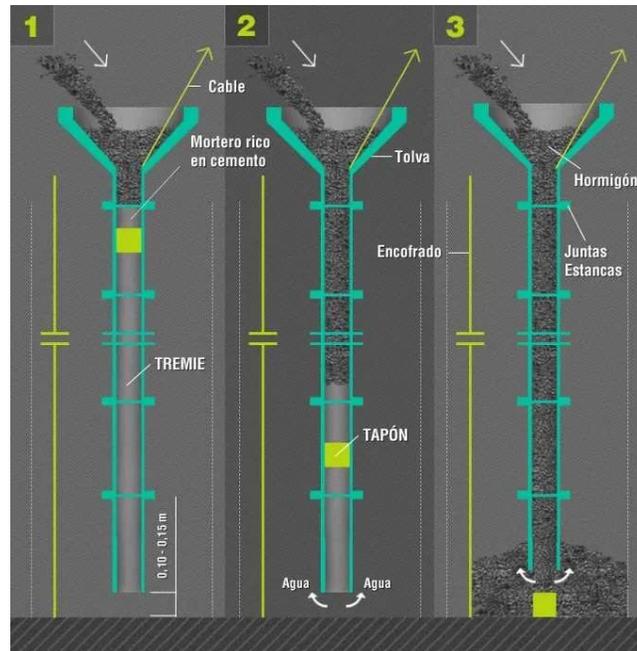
Concepto de hormigonado mediante un tubo de tremie⁴
